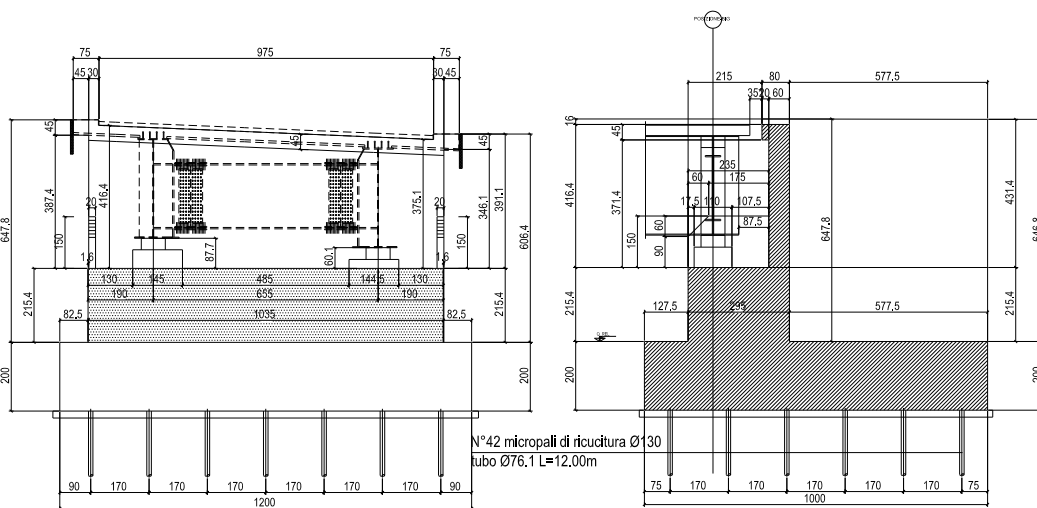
Vista frontale e sezione longitudinale spalla SP2
